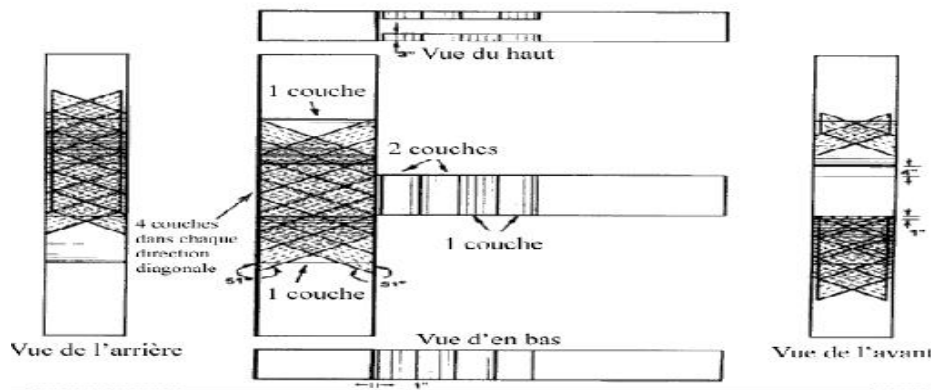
Plan du renforcement du composite (Pantelidis et coll. 2000).
